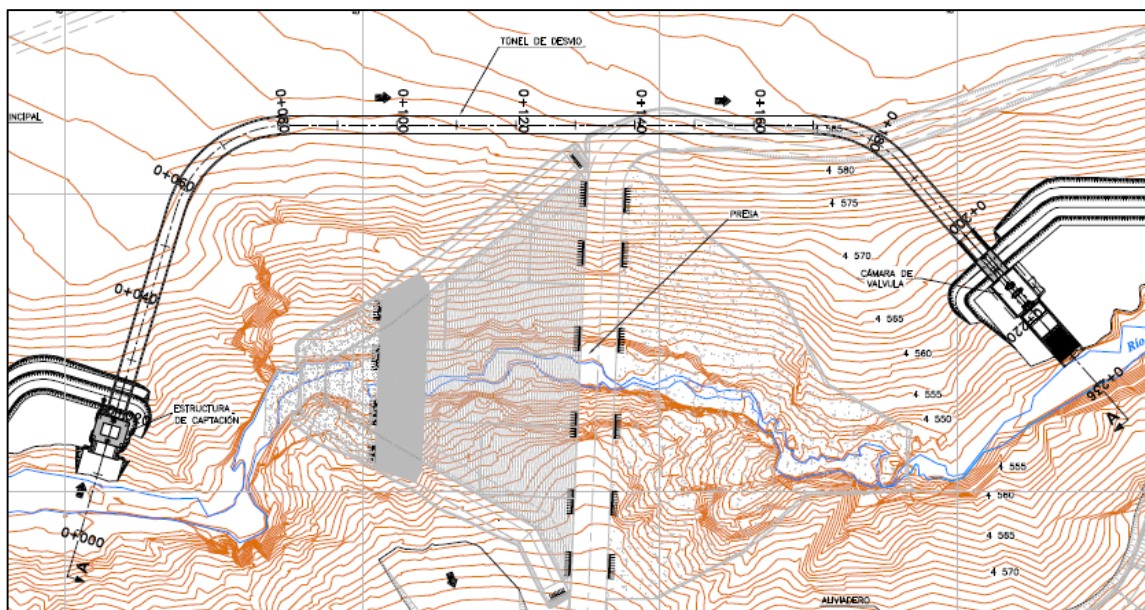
Vista en planta del Túnel de desvío de la presa Pumamayo
